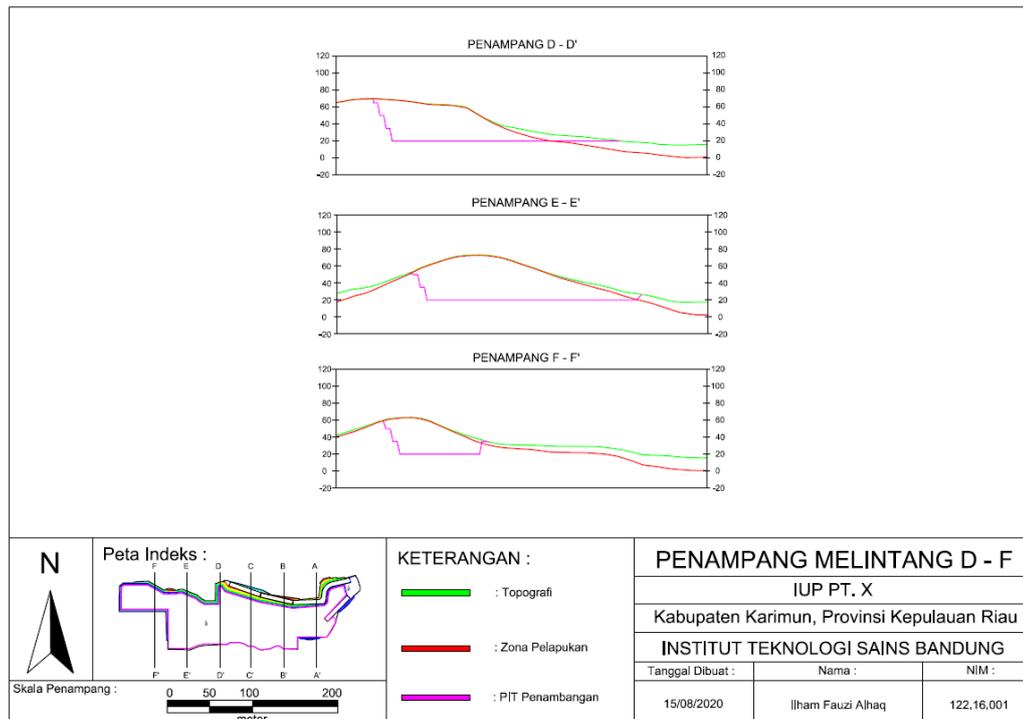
Rancangan Desain PIT Tahun ke-6
